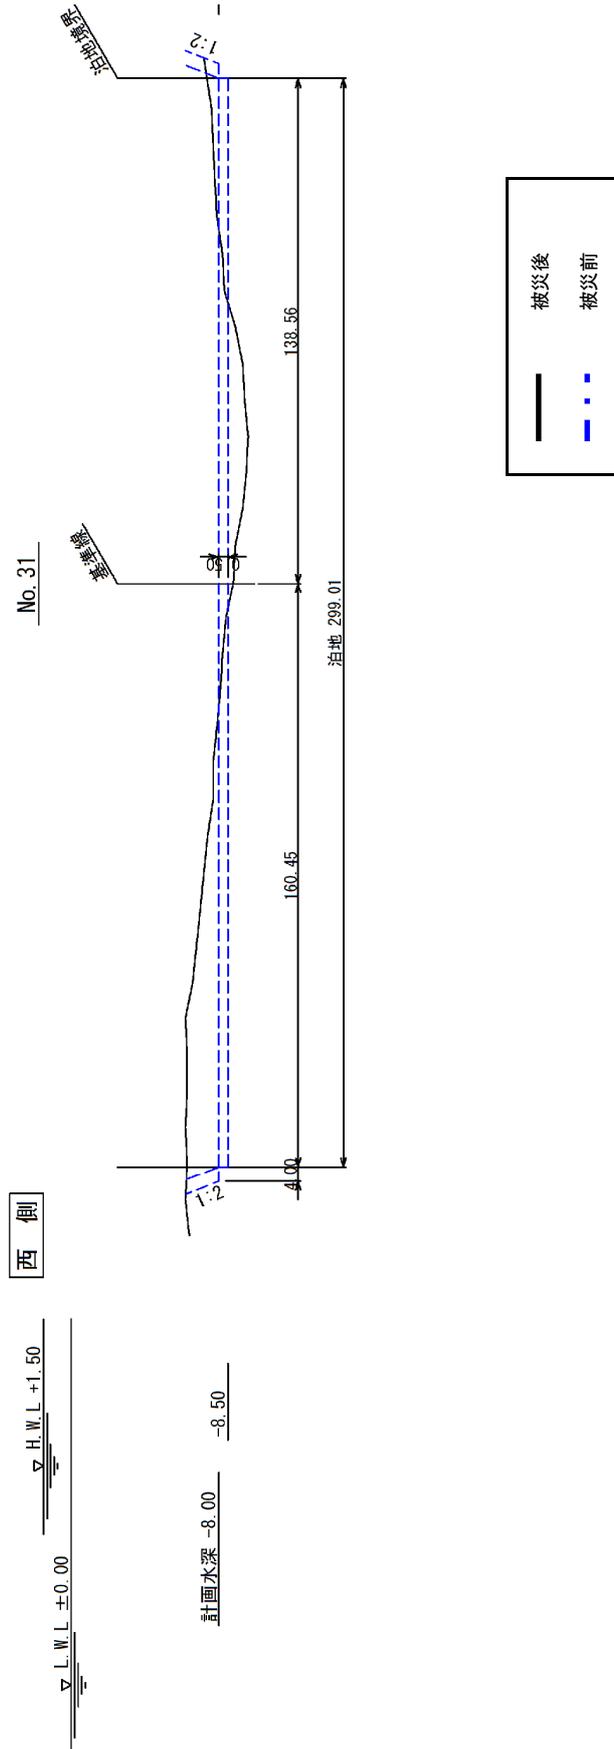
No.2 大洗港区_中央地区泊地 (-8m) の断面図 (被災後)
